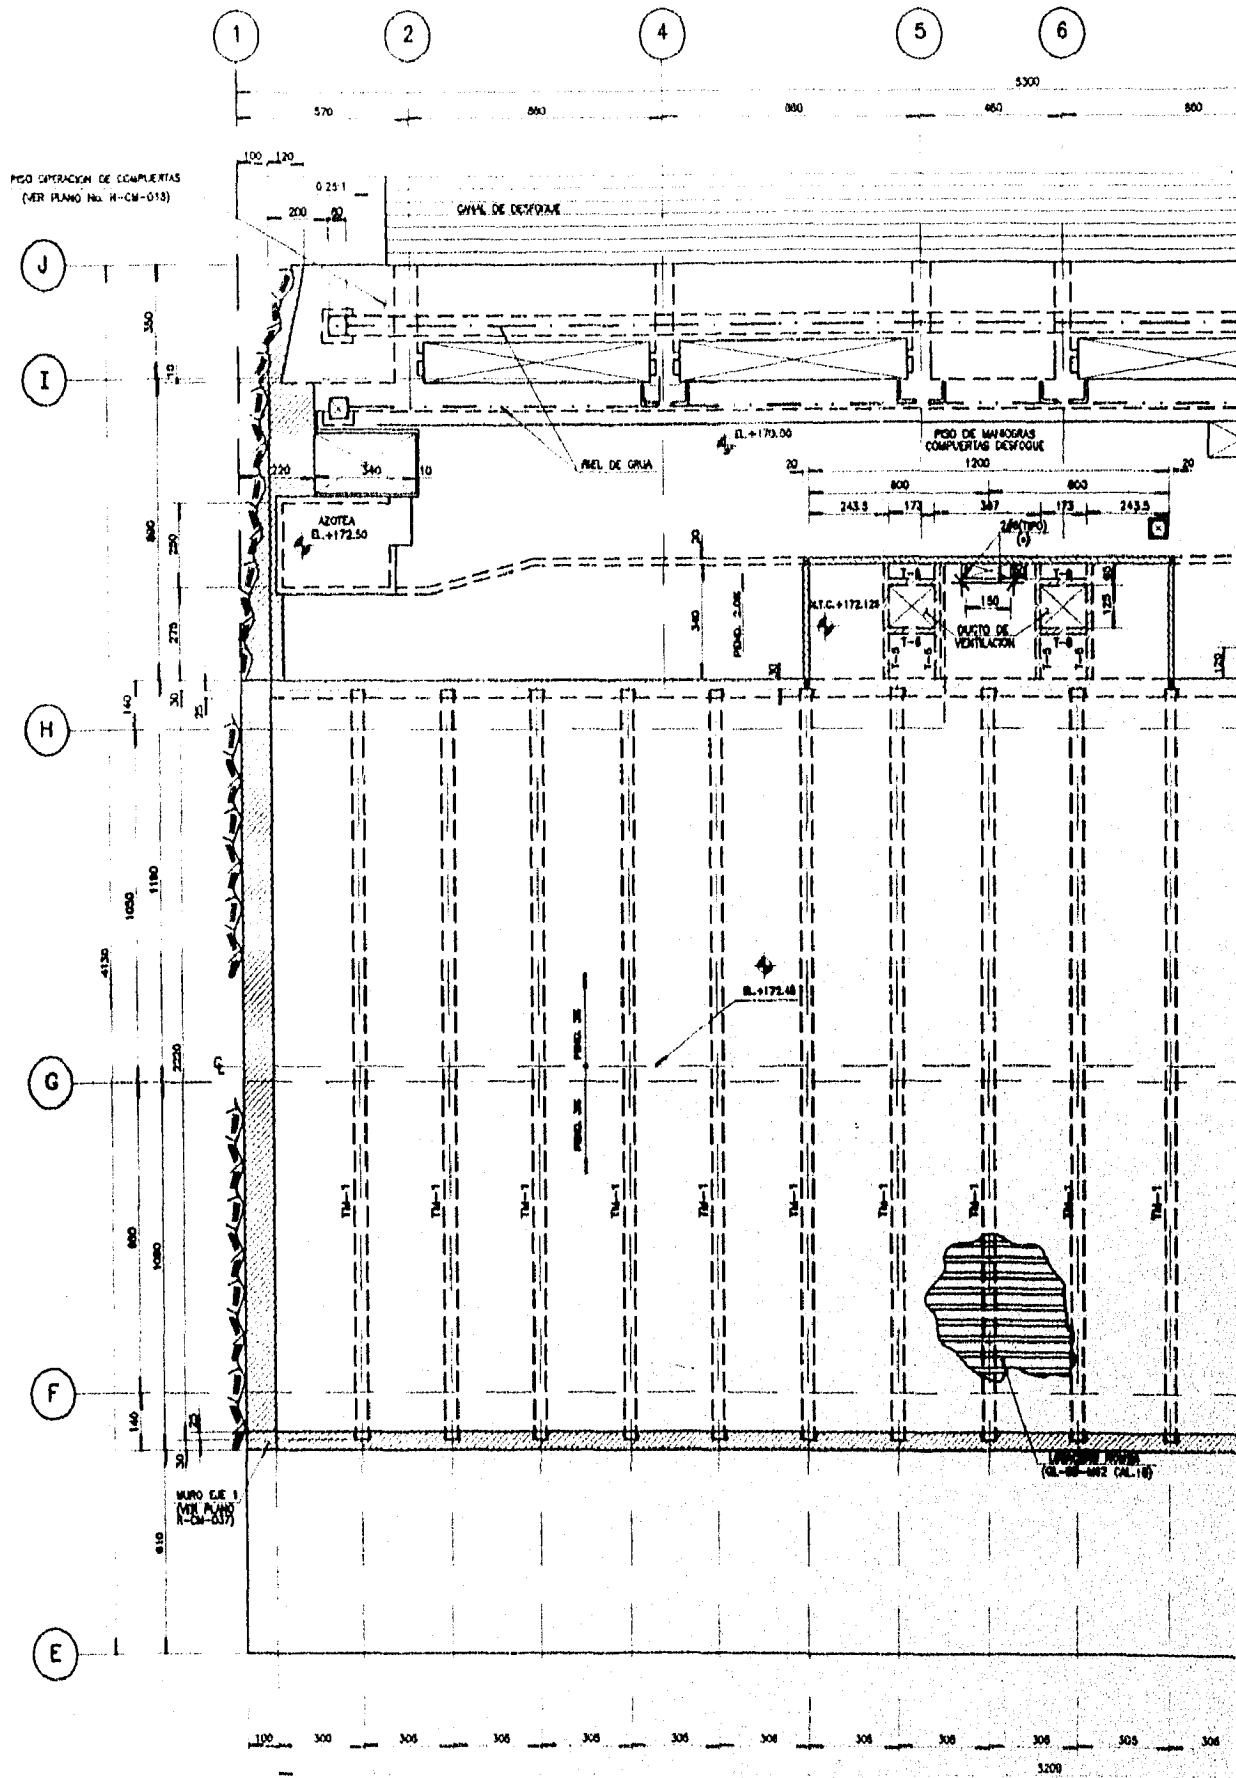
ESTRUCTURACION DE LA ALTERNATIVA DE A
